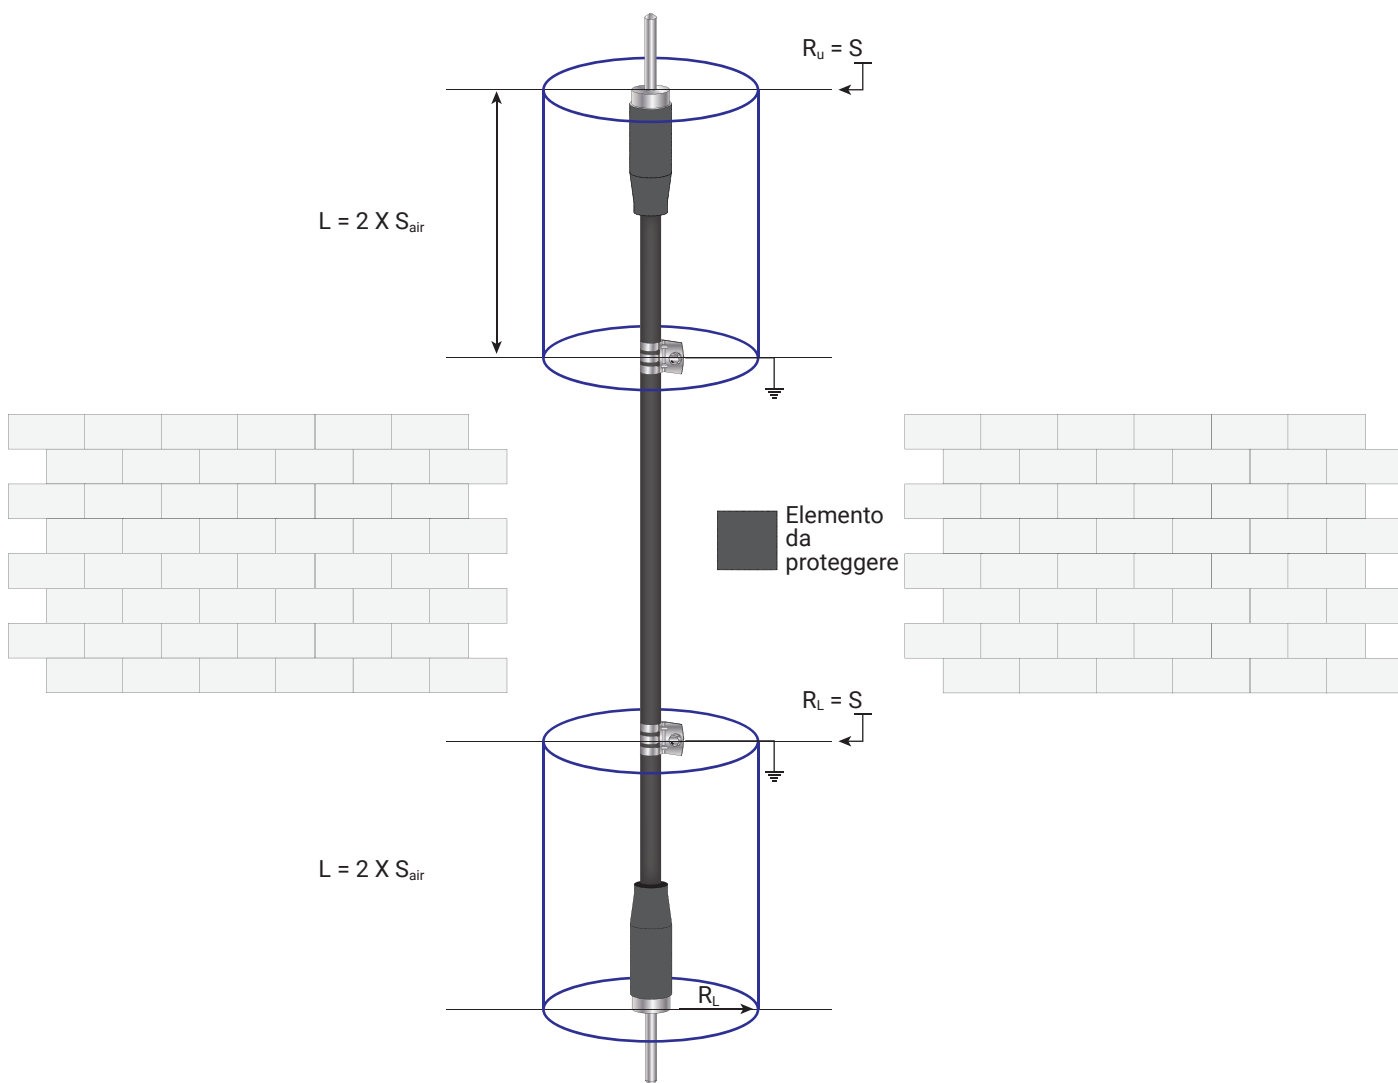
Zone libere durante la protezione di un particolare elemento dell'apparecchiatura
